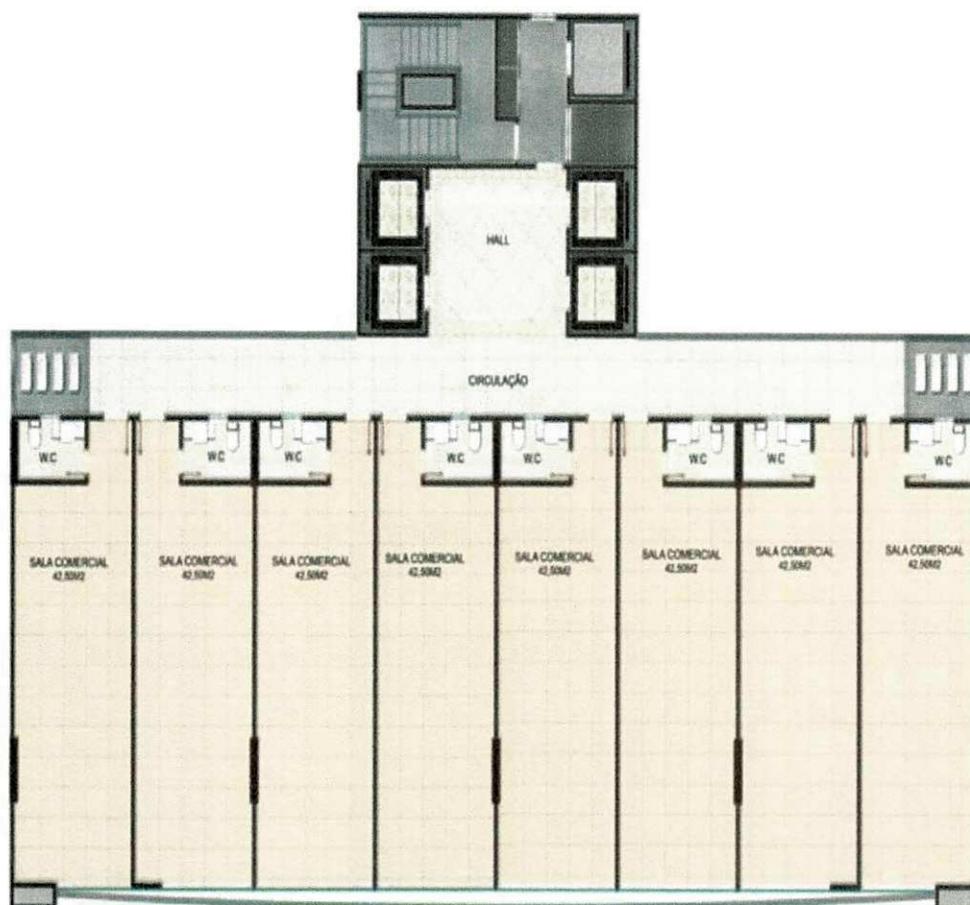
Planta baixa do Mundo Plaza, Bloco A. Fonte: <http://fronteiraengenharia.com/>, Acessado em 10/06/2014, 23:14.
